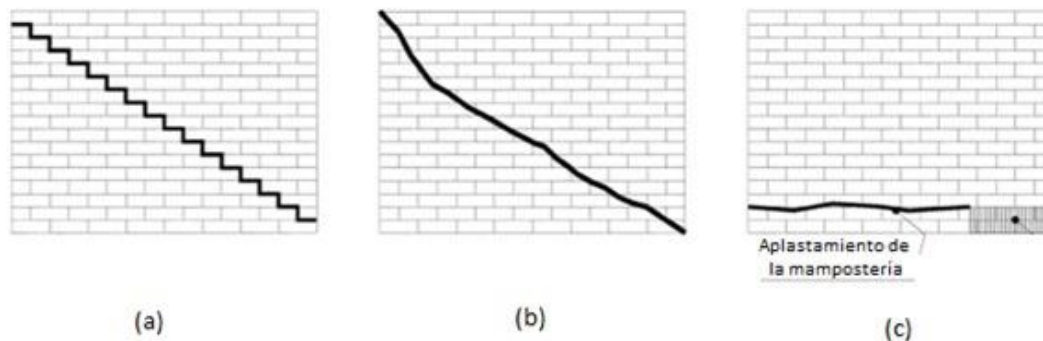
Modos de falla de la mampostería no reforzada sometida a cargas en su plano.
